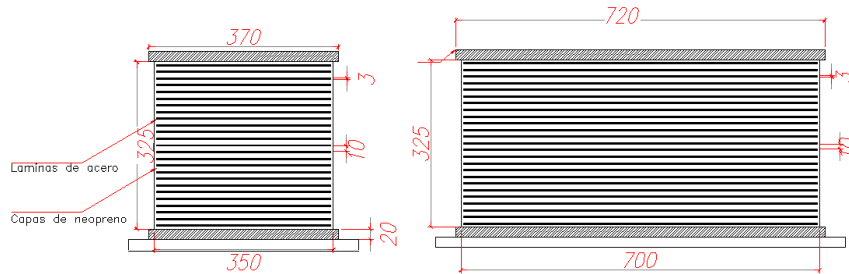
Detalle sección transversal y longitudinal apoyos de neopreno en estribos.
